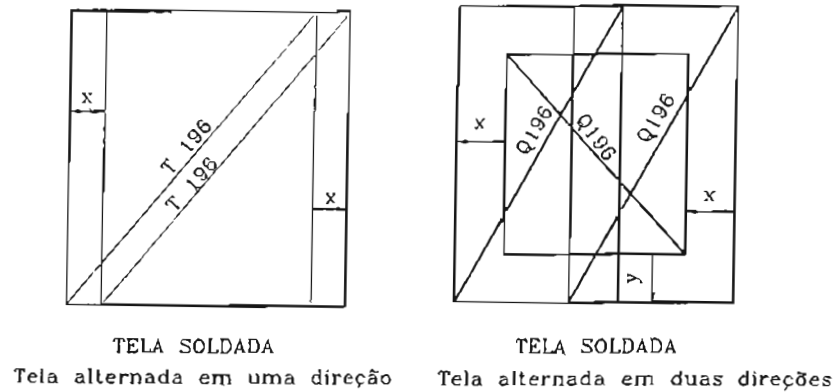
Telas alternadas em uma ou em duas direções para satisfazer o detalhe da diminuição de armadura nos bordos da laje.
